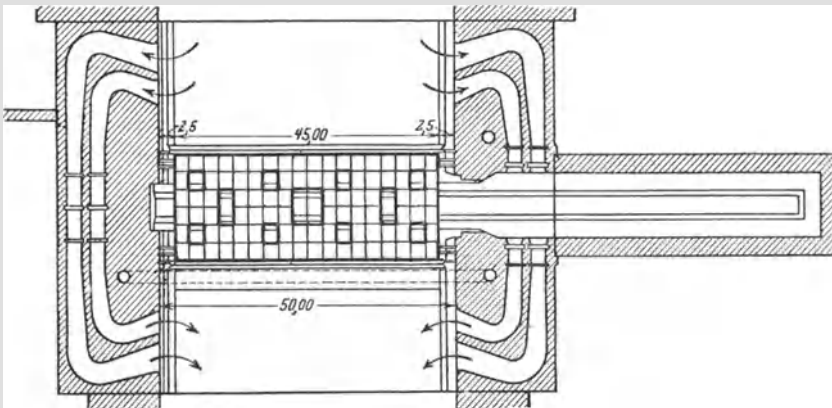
a. Torkammerausbildung. Grundriß Maßstab 1 : 1270.
